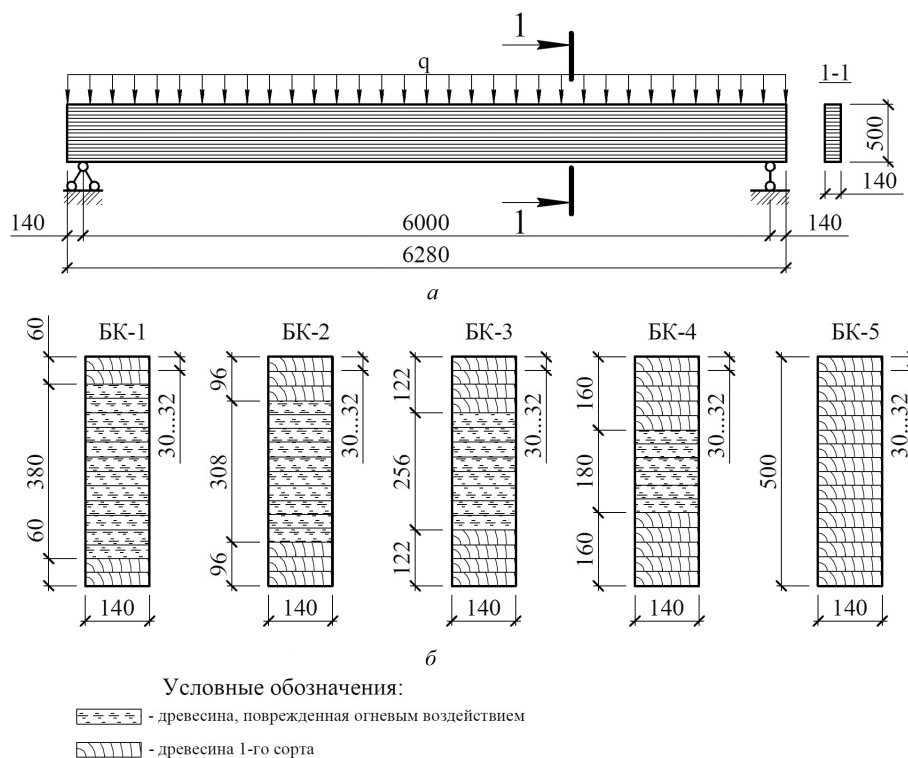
Модель исследуемой деревоклееной конструкции: *a* – расчетная схема; *б* – сечения деревоклееной балки: БК-1–БК-4; БК-5 – «эталонная» балка из древесины 1-го сорта (*q* – равномерно распределенная нагрузка)
